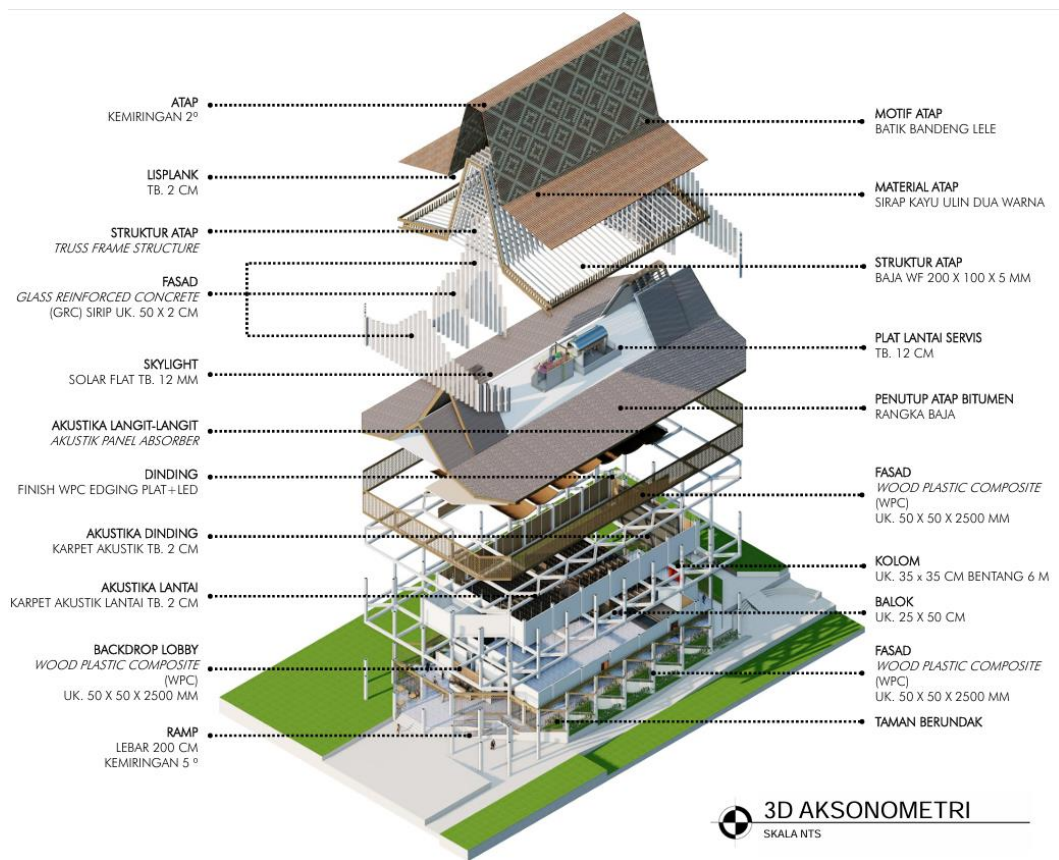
Aplikasi Struktur dengan Sistem Truss
